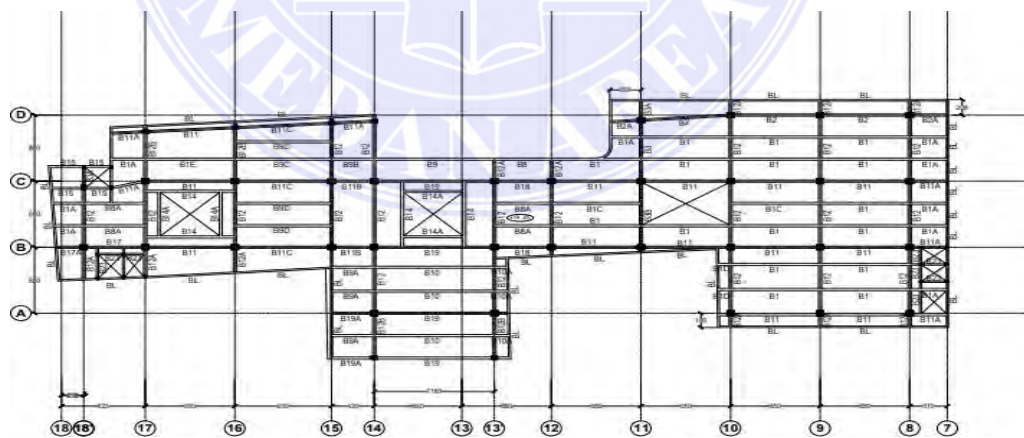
Denah Penulangan Balok Lantai 3
